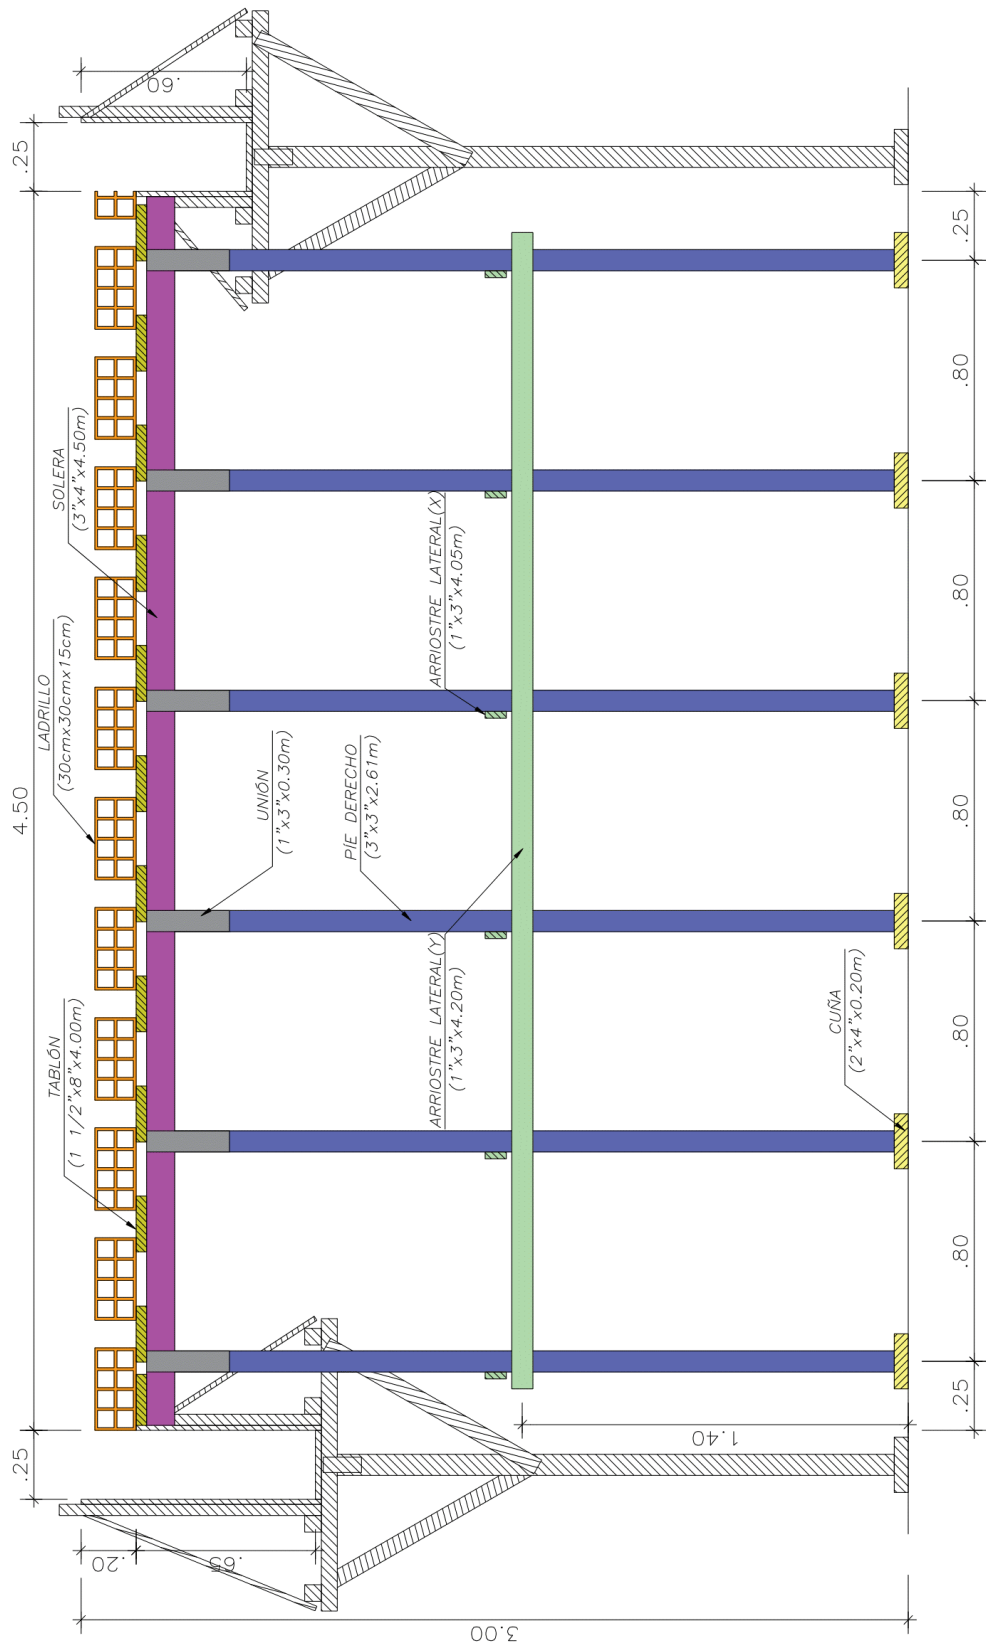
Corte Longitudinal B – B, para la Losa Aligerada Unidireccional Convencional.
